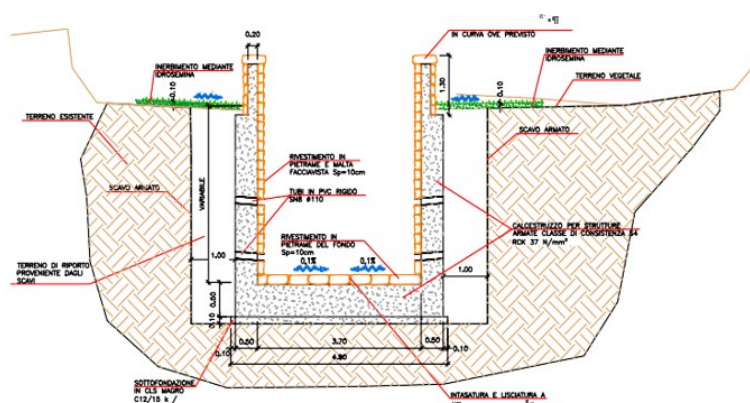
Rio Bau Argili Sezione di progetto a monte del ponte sulla Via Bariocce
